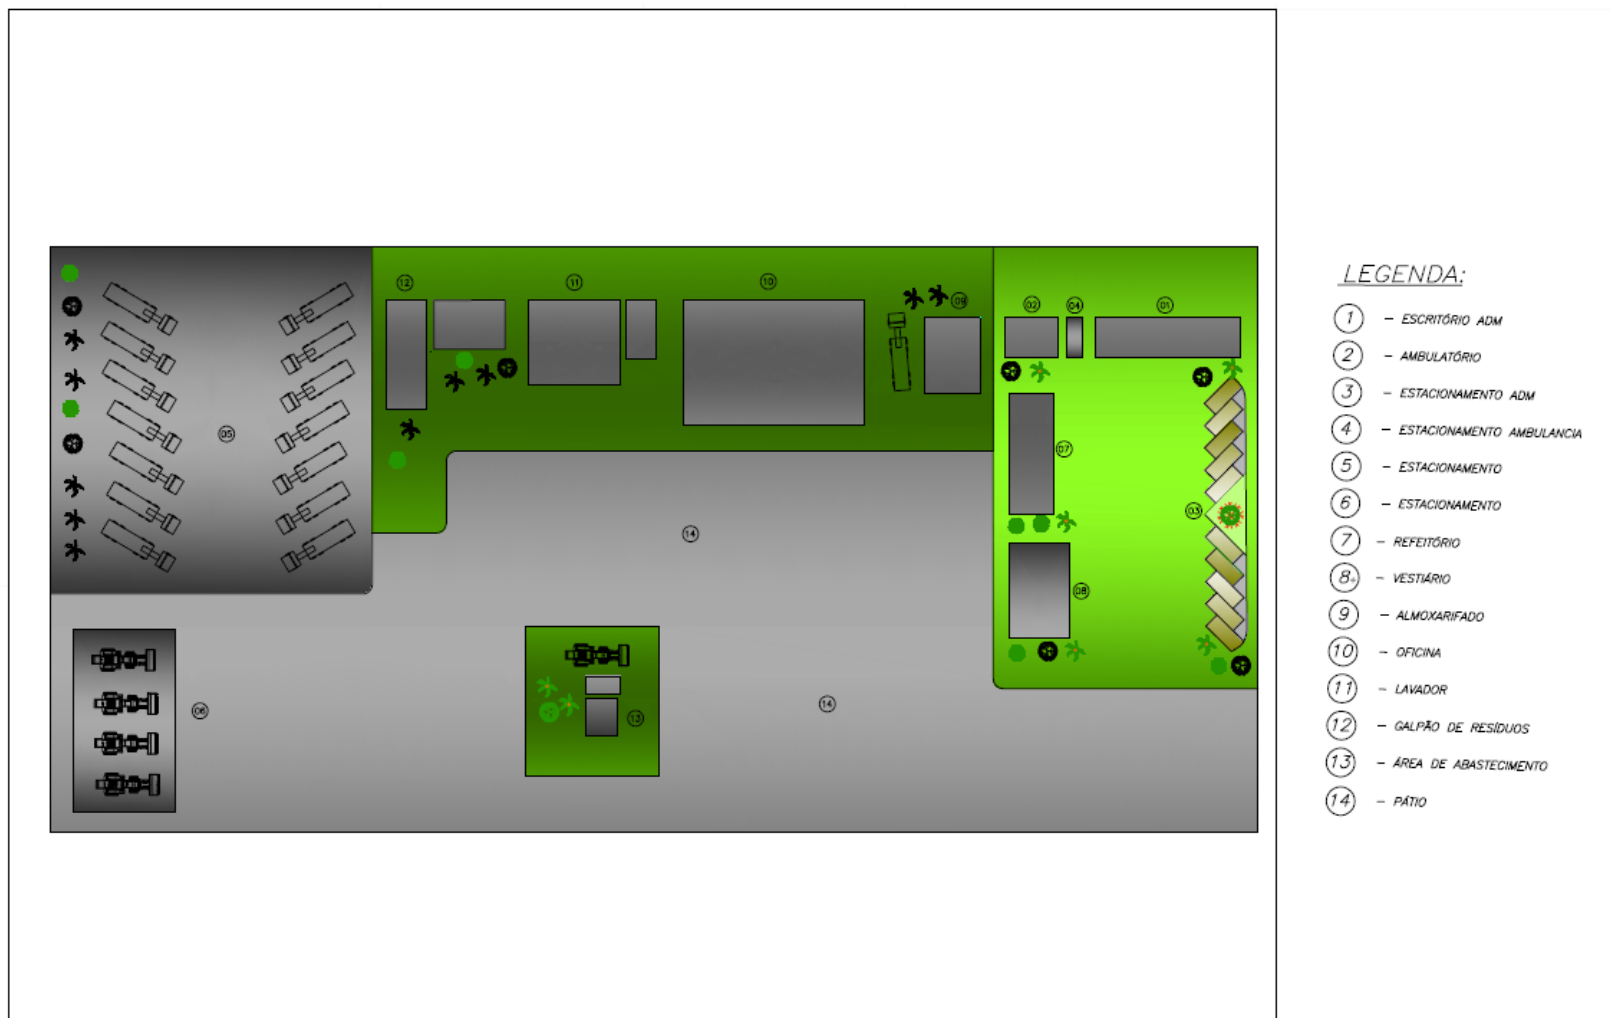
Layout do Canteiro de Obras da Pedreira – TUP BAMIN - Porto Sul
